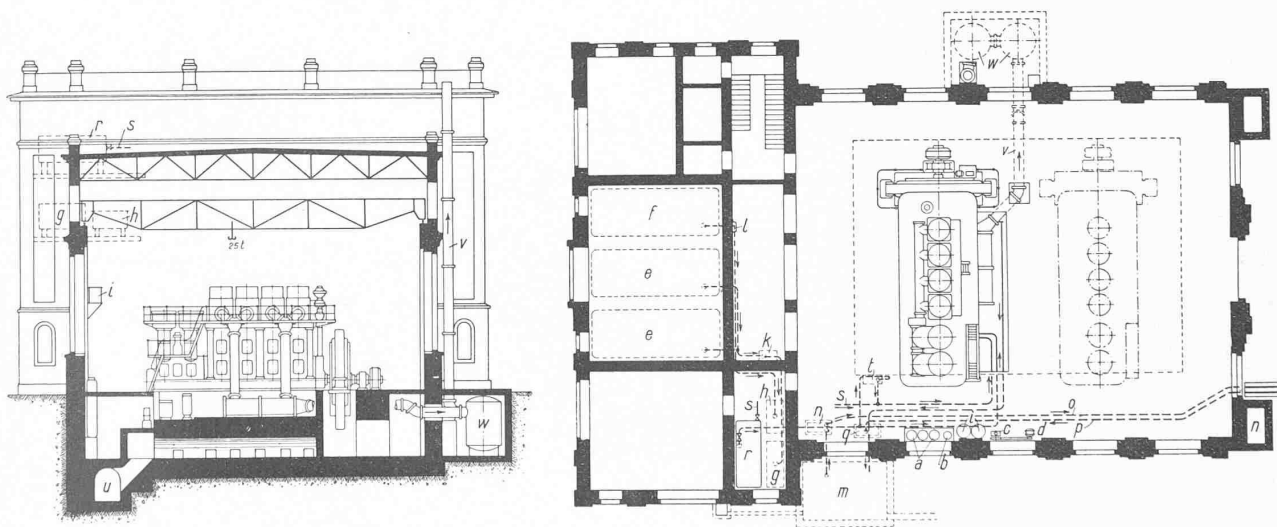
und 8. Vertikalschnitt und Grundriss des Reservekraftwerks mit Bezeichnung der Hilfseinrichtungen. — Masstab 1:400.
